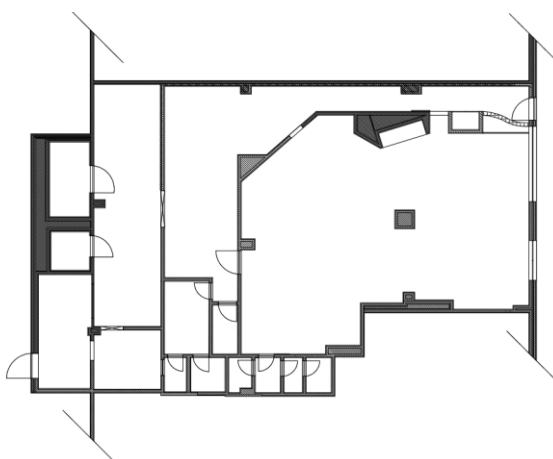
Levantamento da Planta Atual da Pastelaria. Fonte: Autora, 2025
